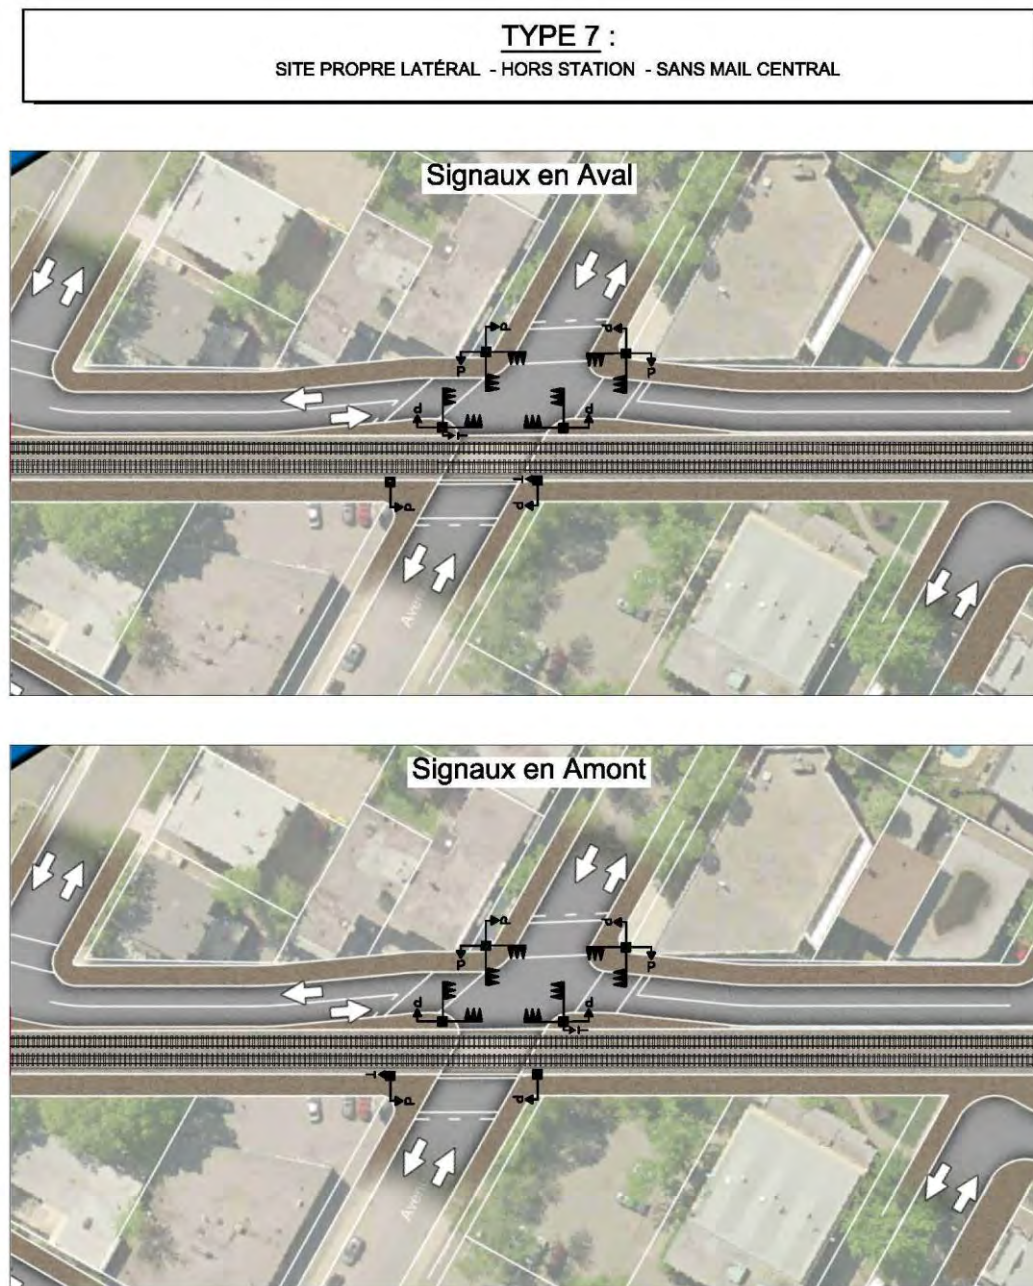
Disposition des signaux lumineux aux carrefours pour le tramway en site propre en position latérale – hors station – sans mail central
